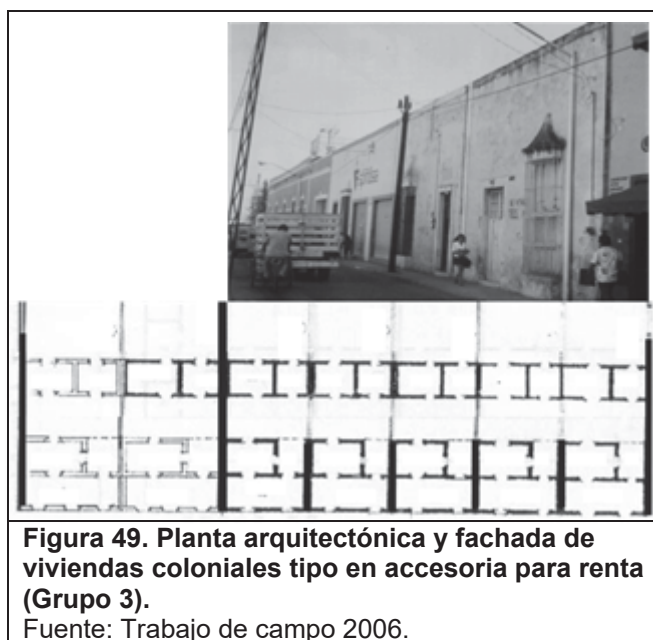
Planta arquitectónica y fachada de viviendas coloniales tipo en accesoria para renta (Grupo 3).
